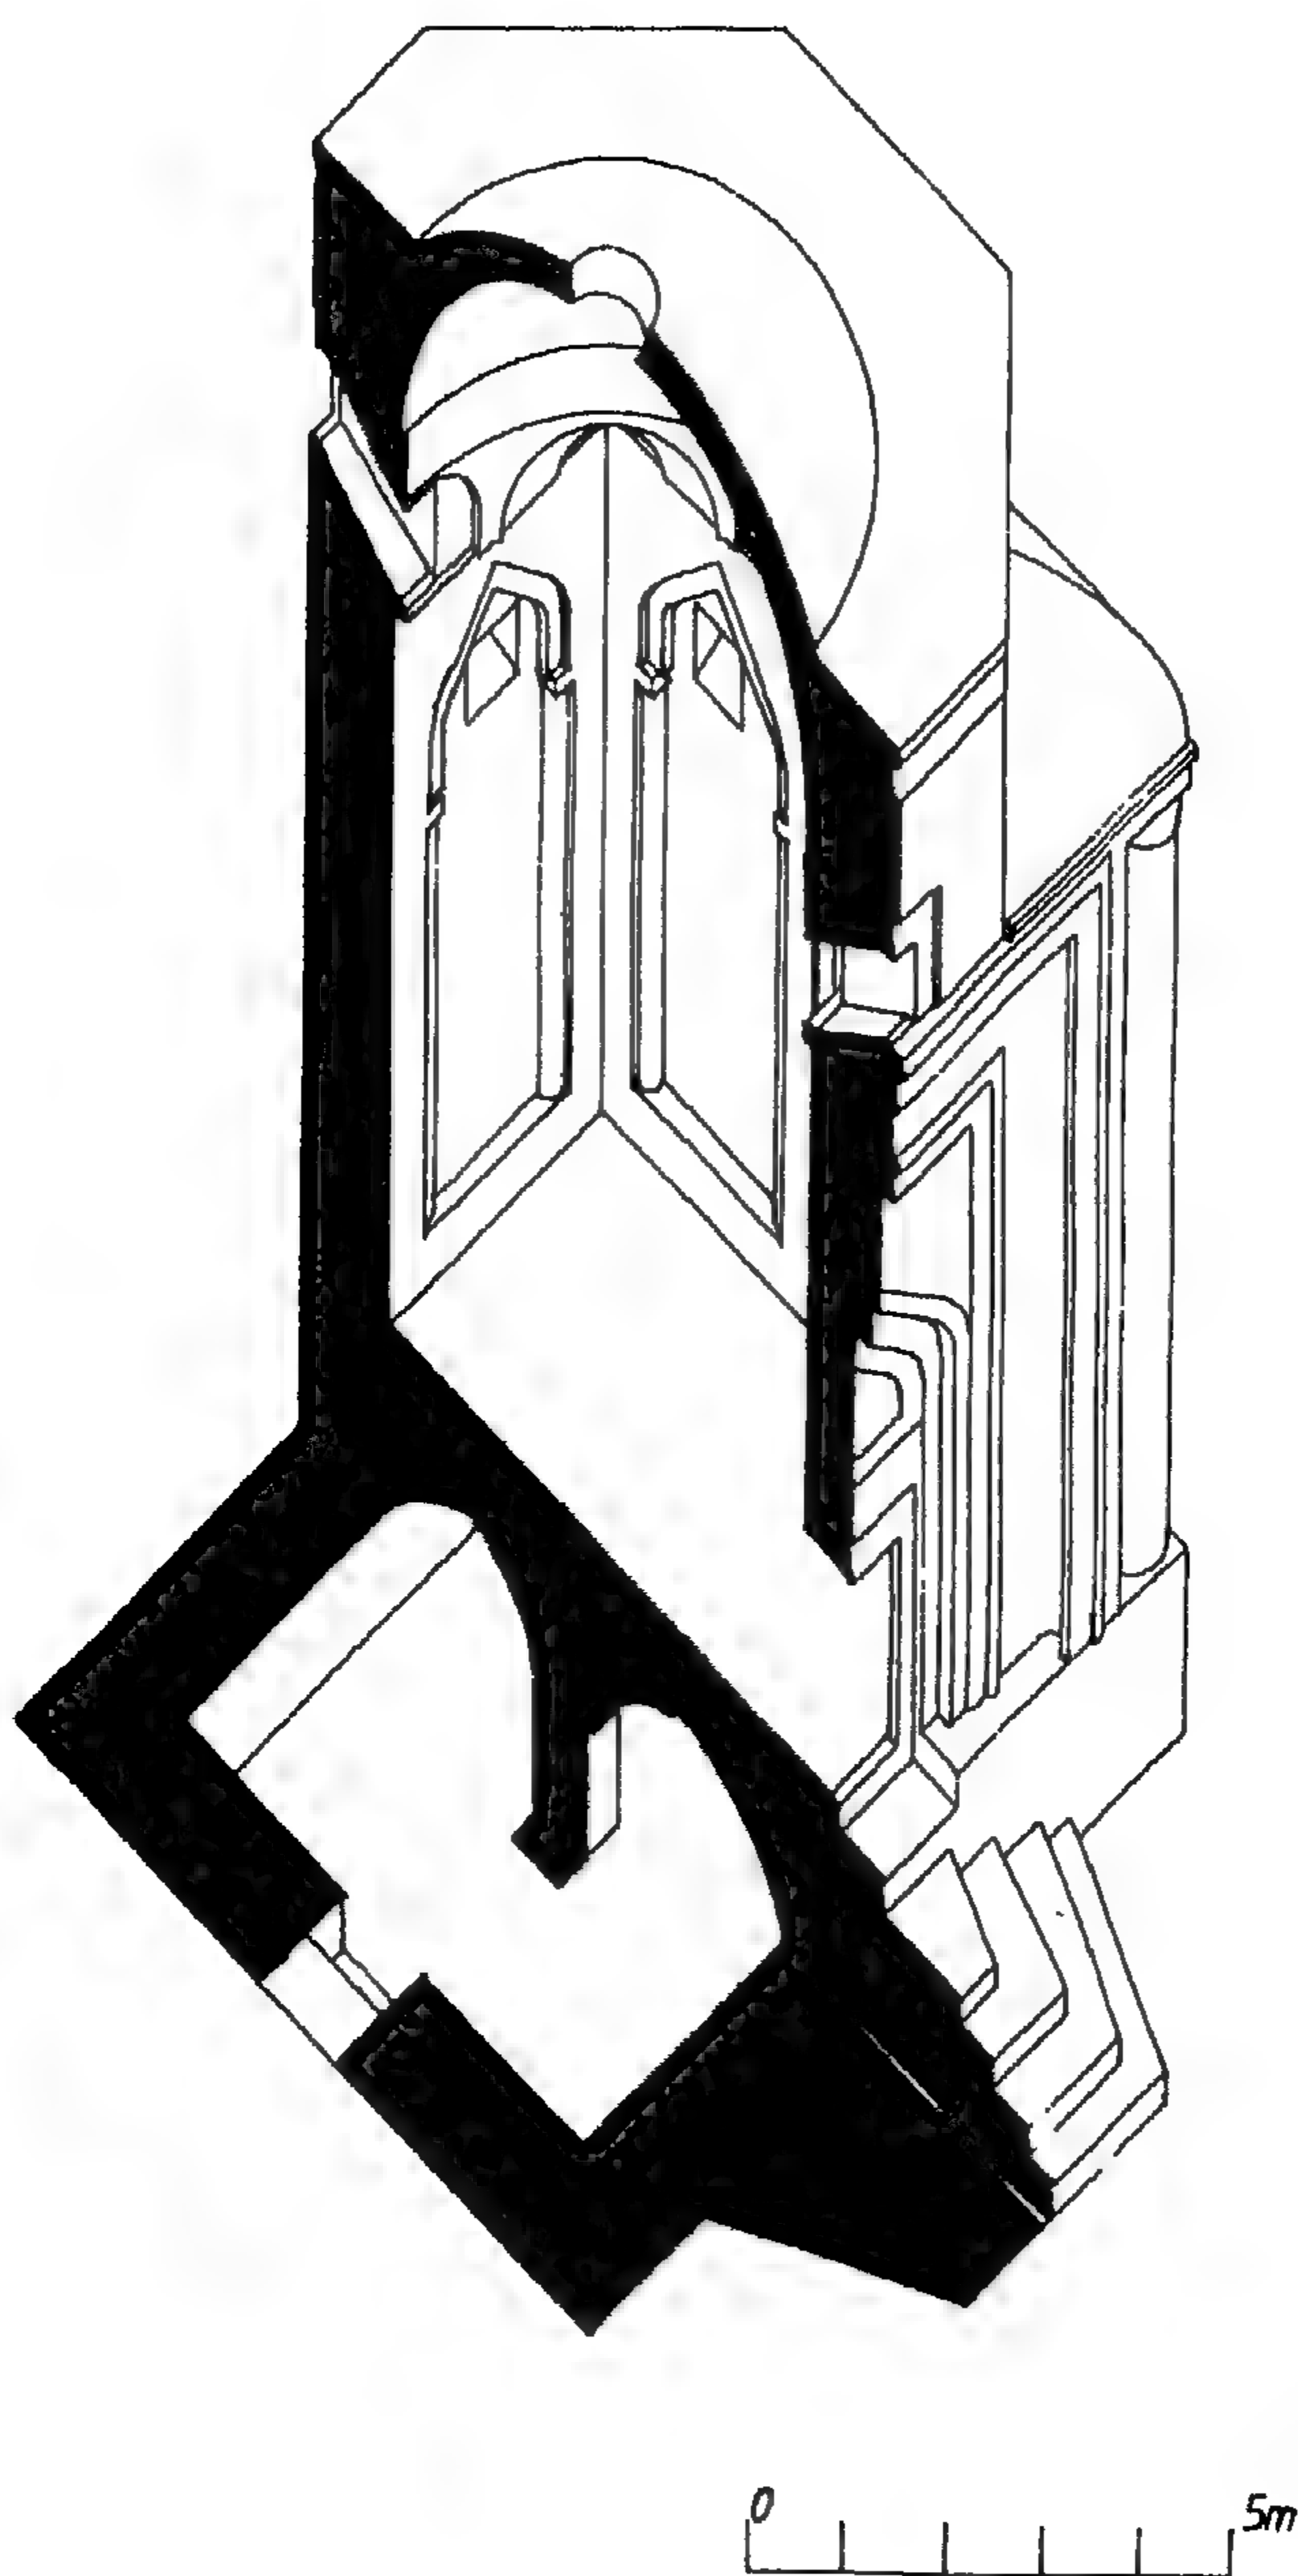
مسقط أفقى لتربة إبراهيم باشا فى فوتجا (عن : Pašić) .
